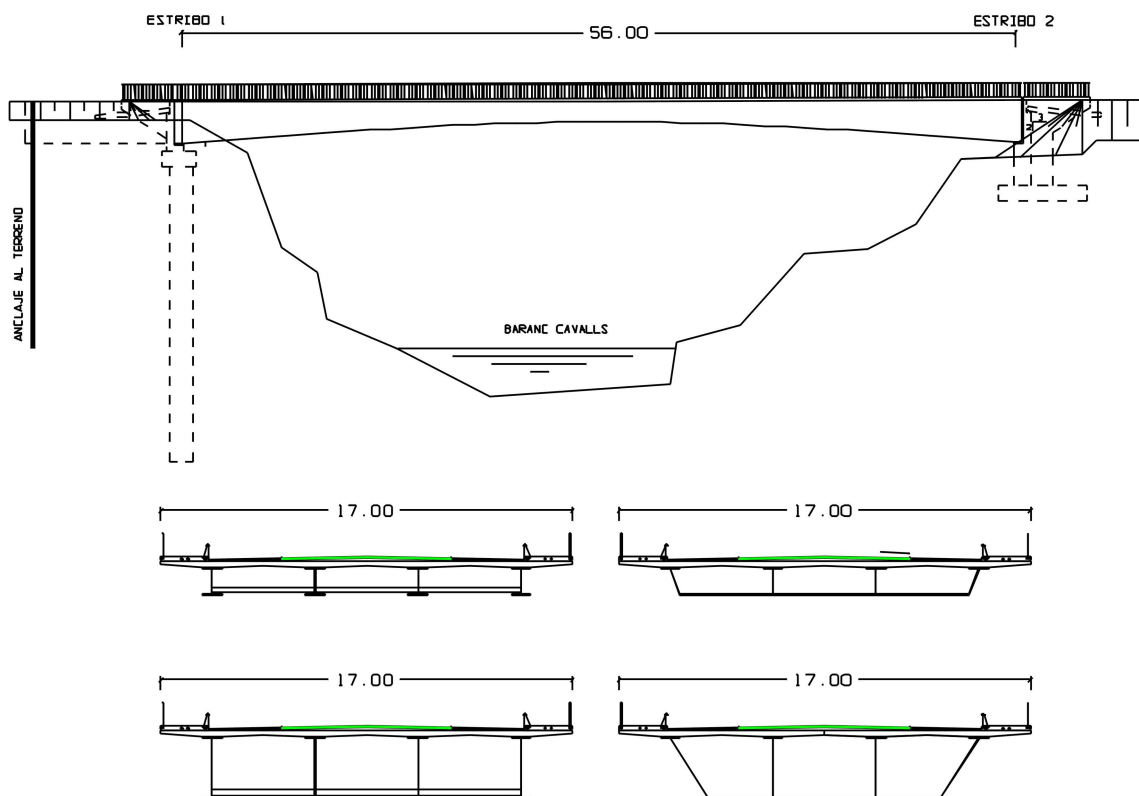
Solución nº 3. Viga biempotrada mediante anclajes en los estribos.
